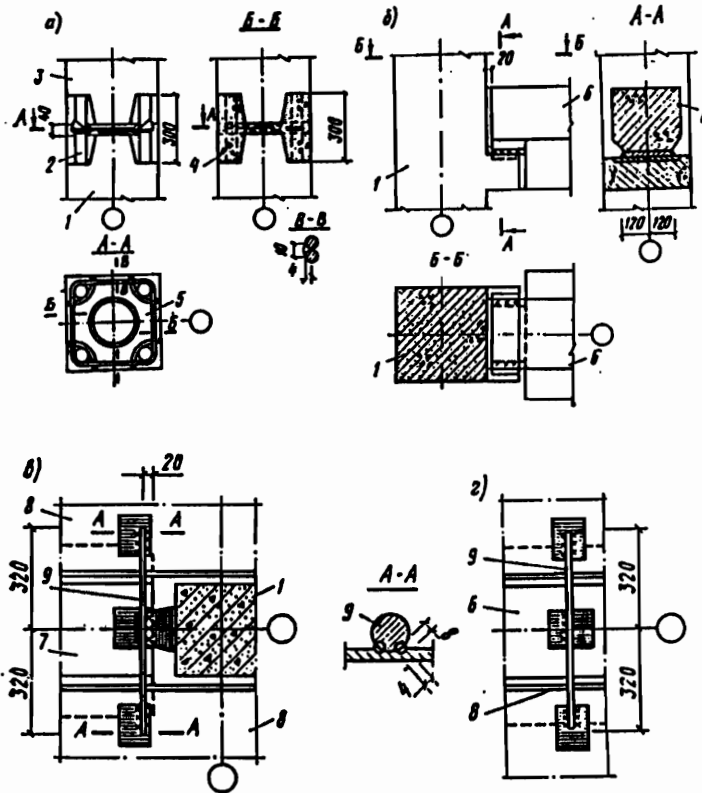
Узлы сопряжения элементов каркаса по связевой схеме: а - стык колонны; б - стык ригеля с колонной; в - стык диафрагмы жесткости с колонной; г - узел сопряжения плит перекрытий; 1 - нижестоящая колонна; 2 - арматурный выпуск колонны; 3 - вышестоящая колонна; 4 - бетон замоноличивания; 5 - арматурный хомут; 6 - ригель; 7 - диафрагма жесткости; 8 - плита перекрытия; 9 - арматурная накладка
